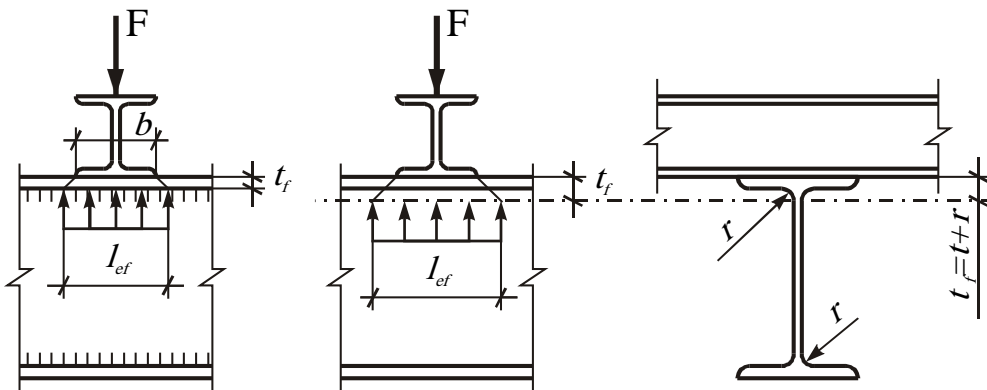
Схема передачі зосередженого навантаження на стінку балки
